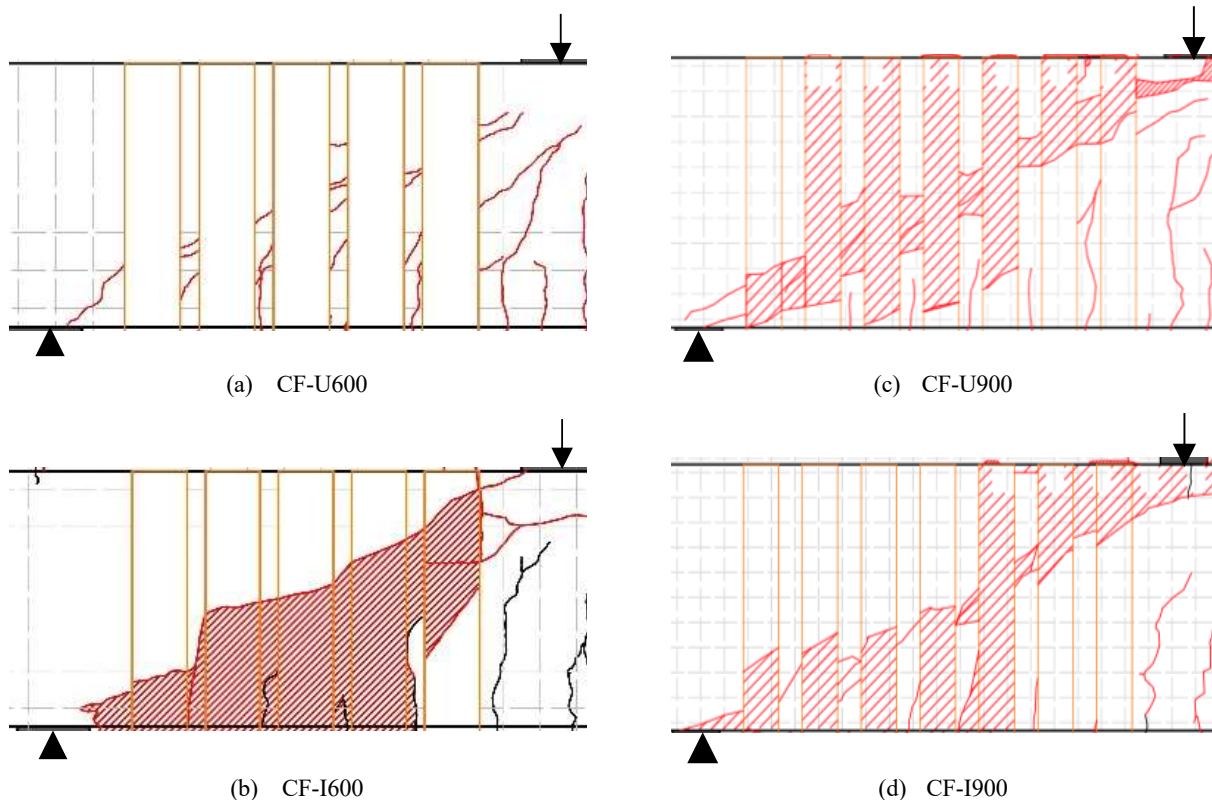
破壊後のひび割れおよびシート剥離の様子
